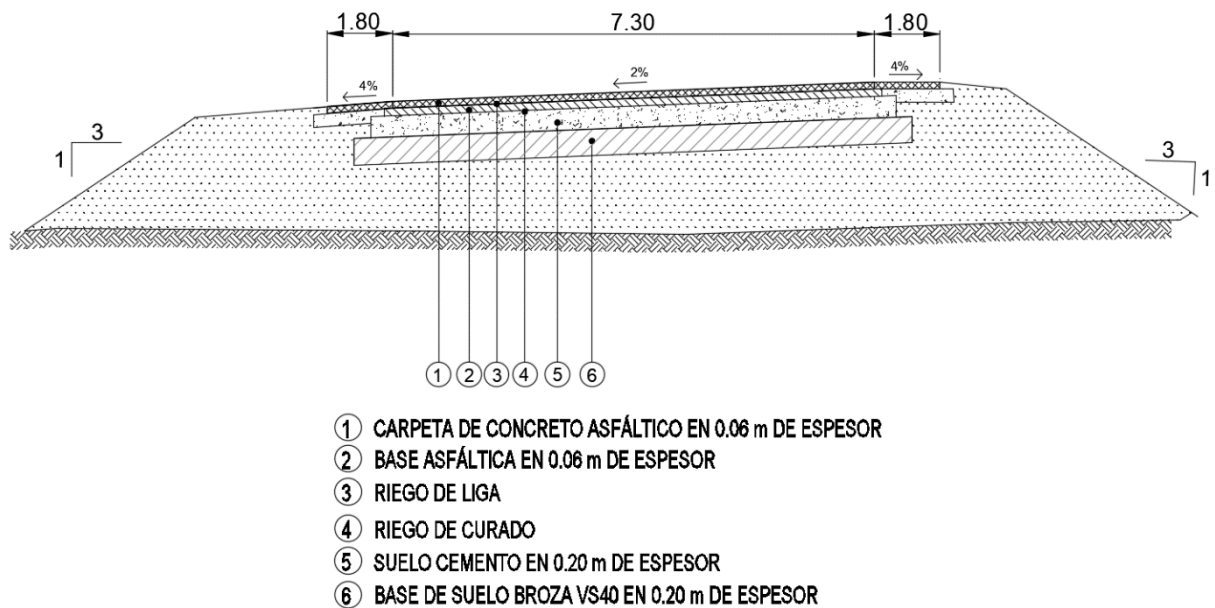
a: Paquete estructural en calzada y ramal
